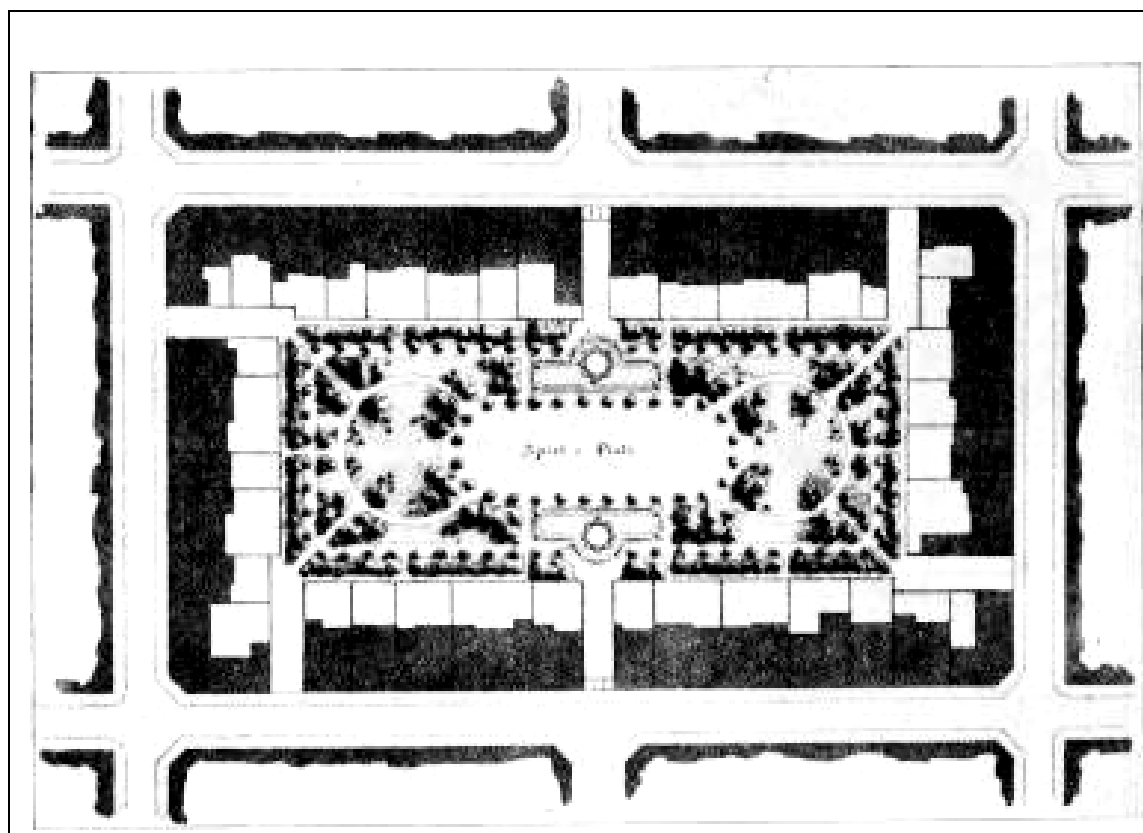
imóveis de vários pavimentos agrupados em quarteirões fechados, para as camadas mais baixas da população.
